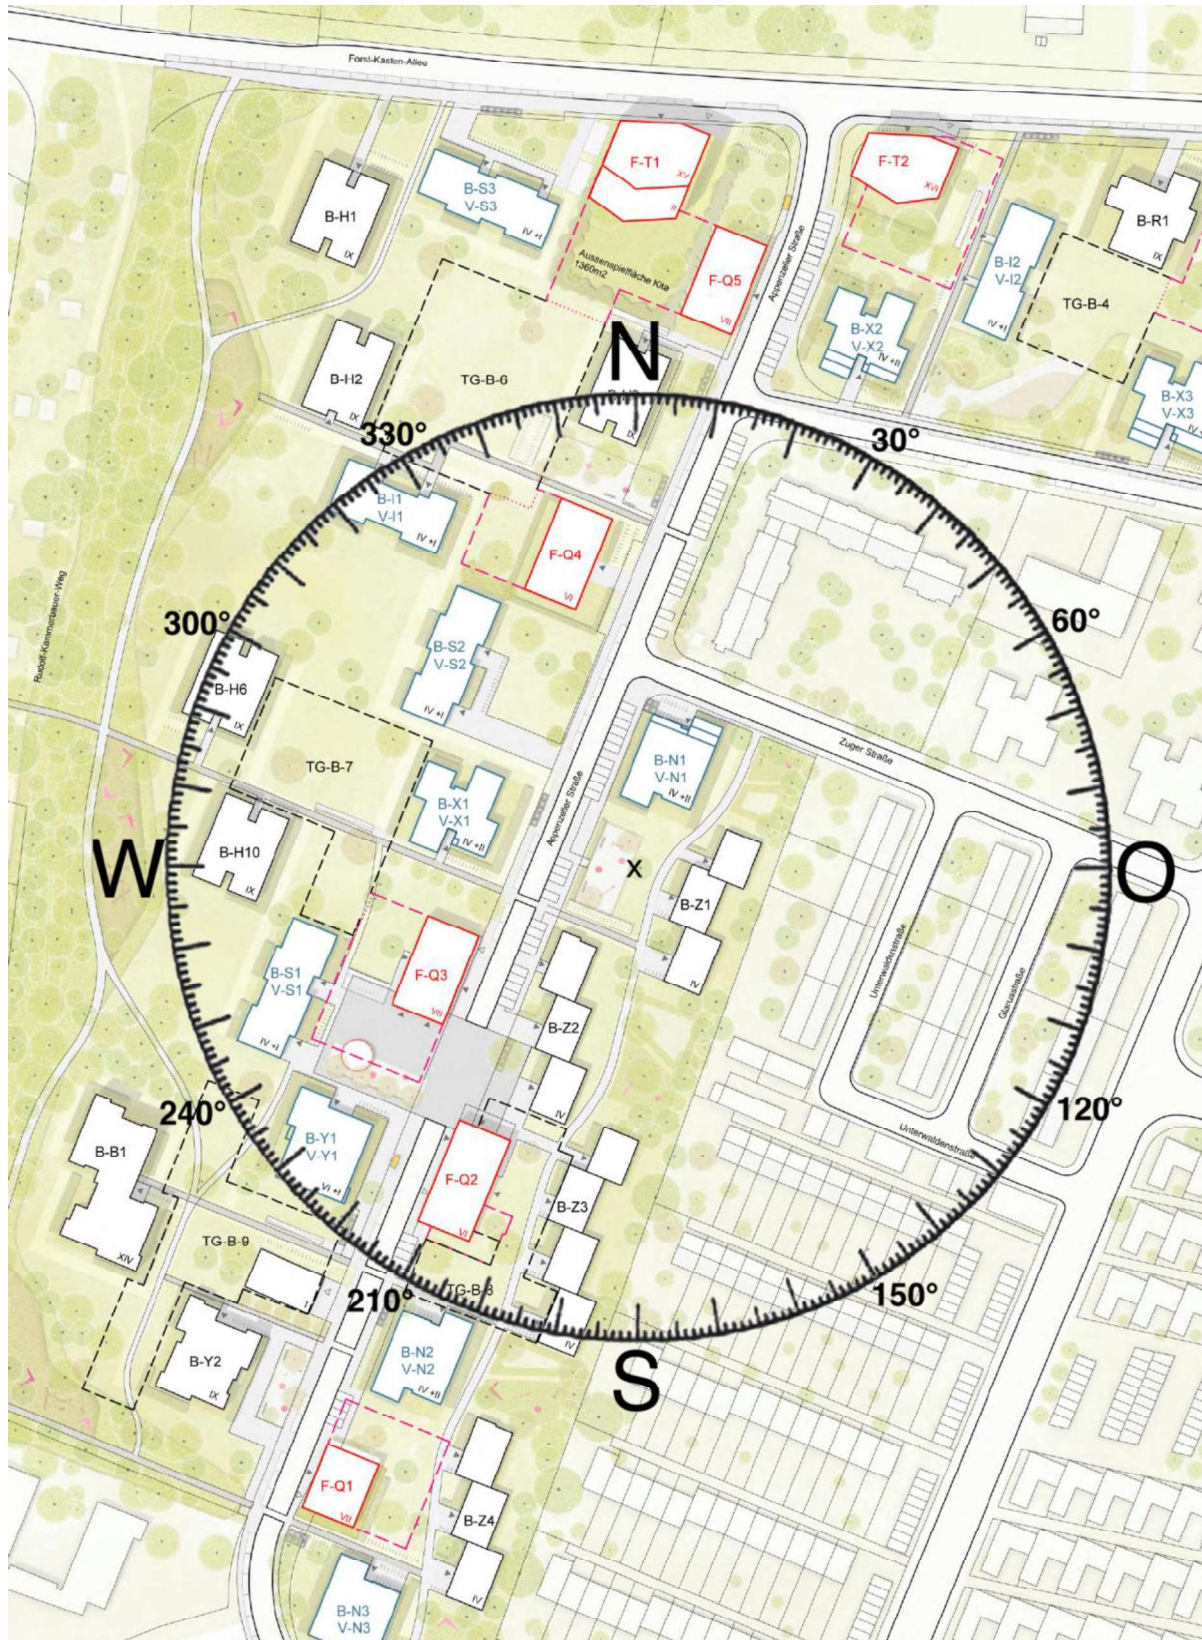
Lageplan der Wohngebäude mit Windrichtungsskala
